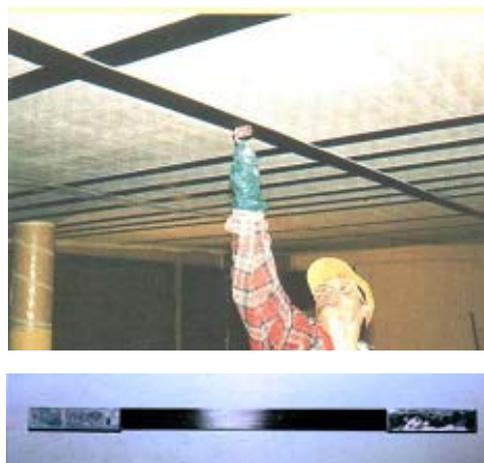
Aplicação do laminado (acima) e detalhe do laminado (abaixo) (Catálogo Sika)
